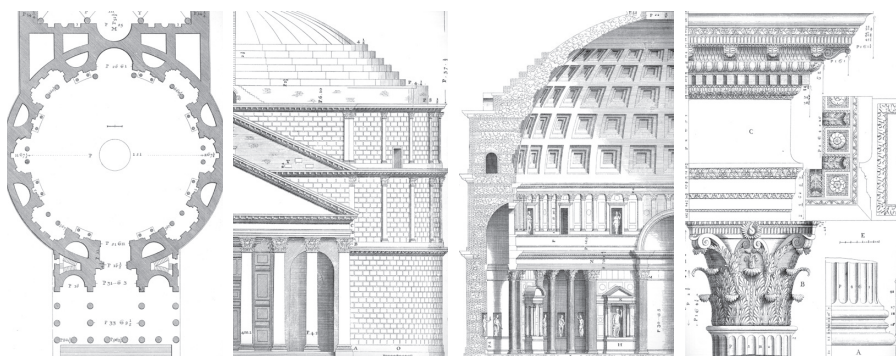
Desenhos do Pantheon romano segundo o grande arquiteto vênето (nascido em Padova) Andrea Palladio (1508-1580). Planta baixa, fachada, corte transversal e detalhe das colunas do pórtico frontal, do tratado *I quattro libri dell'architettura*.
